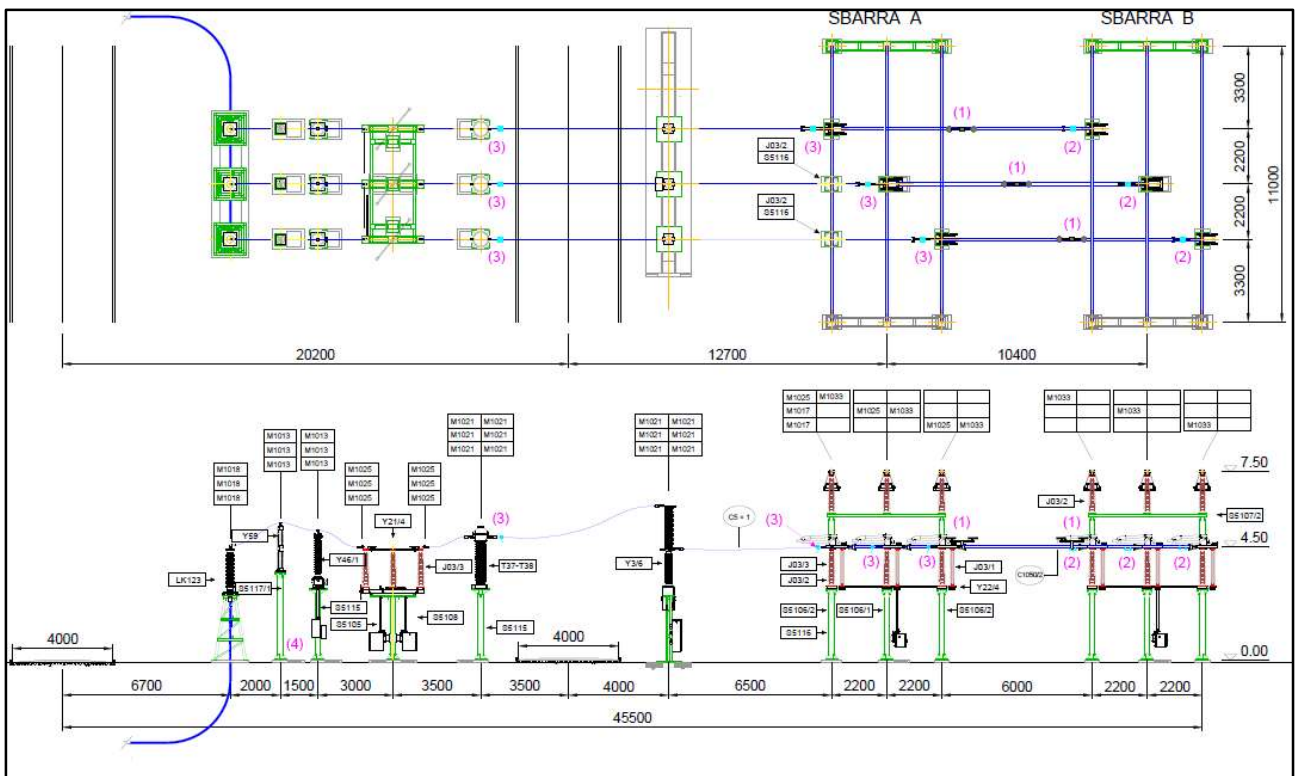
Planimetria e sezione elettromeccanica relativa alle apparecchiature dello stallo 150 kV nella stazione Terna
